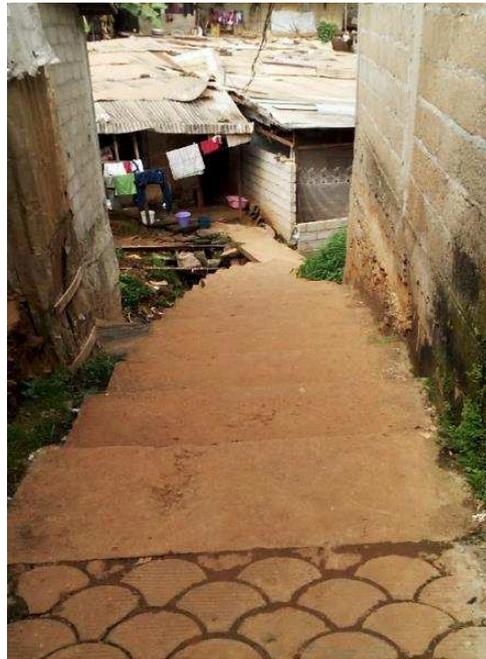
Vue d'une voie en escaliers aménagée avec du béton de ciment dans le quartier Ngoa-Ekellé
